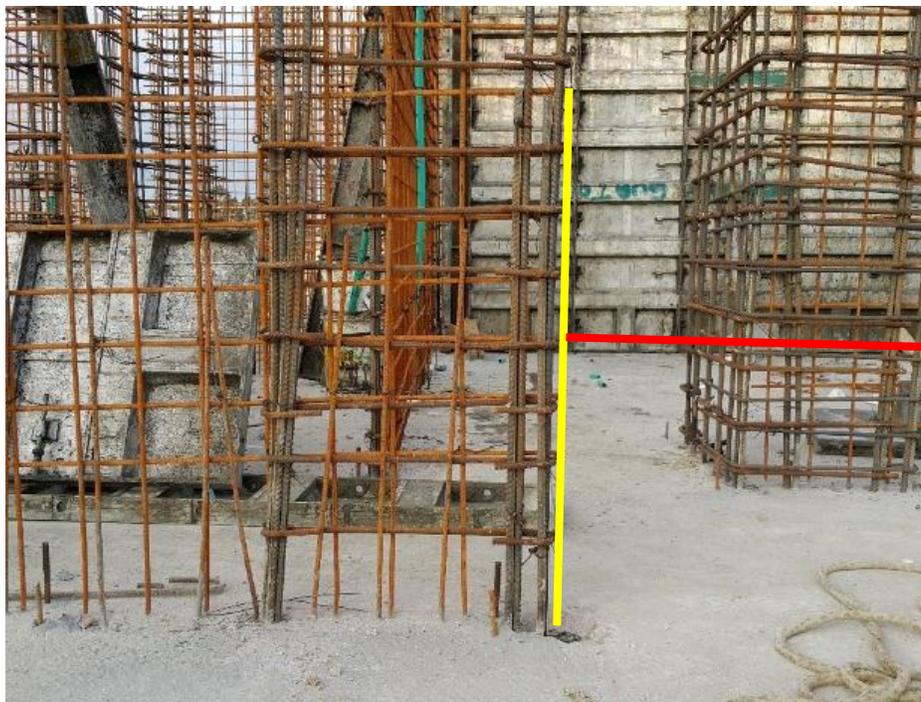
Traslapos de barras en muros. Fuente: Propia
